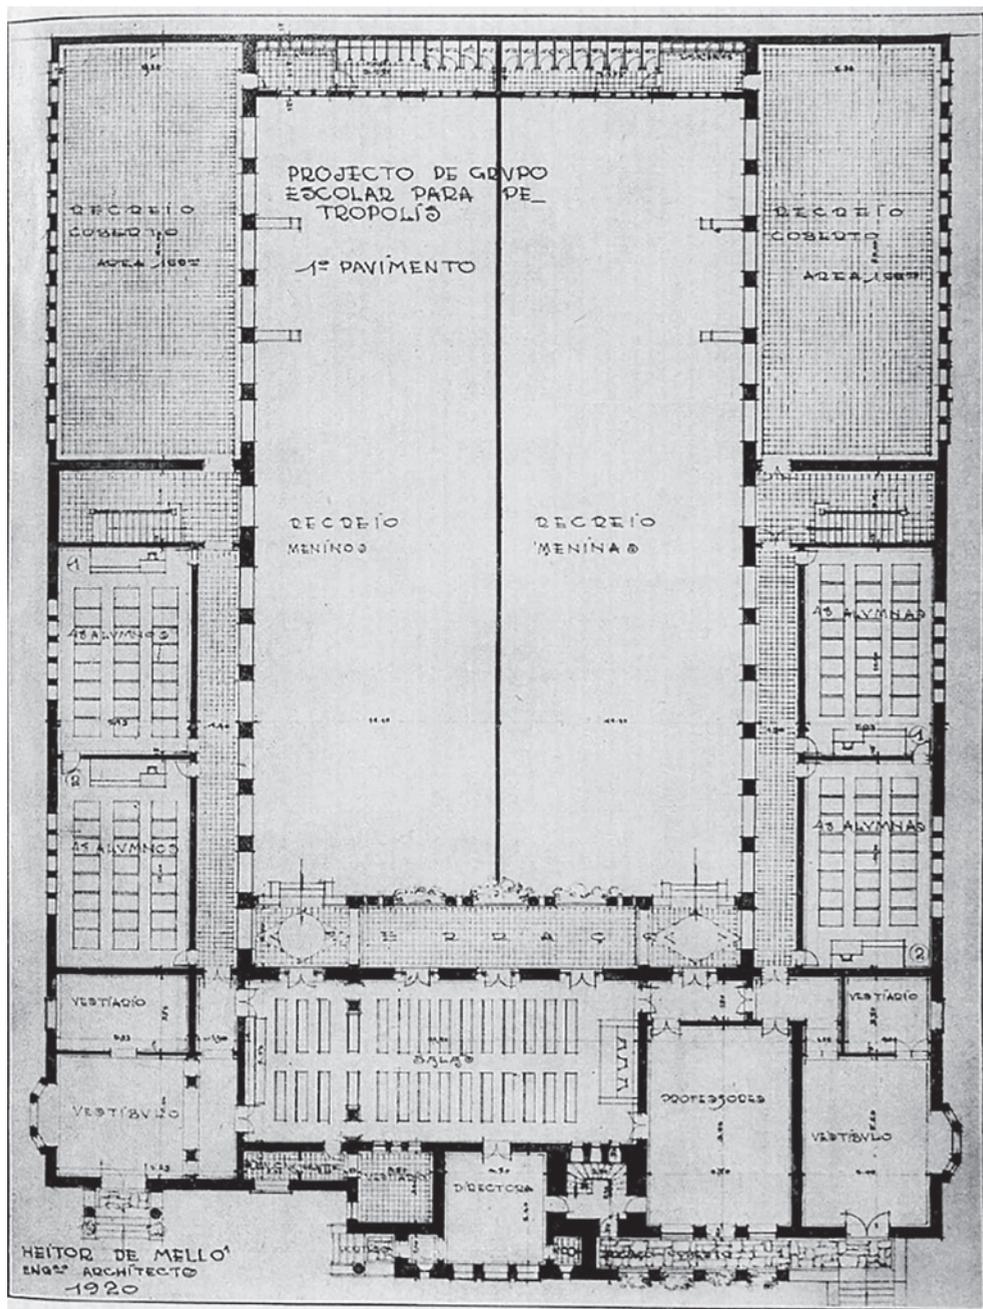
Grupo Escolar Pedro II, em Petrópolis: Planta baixa do primeiro pavimento
